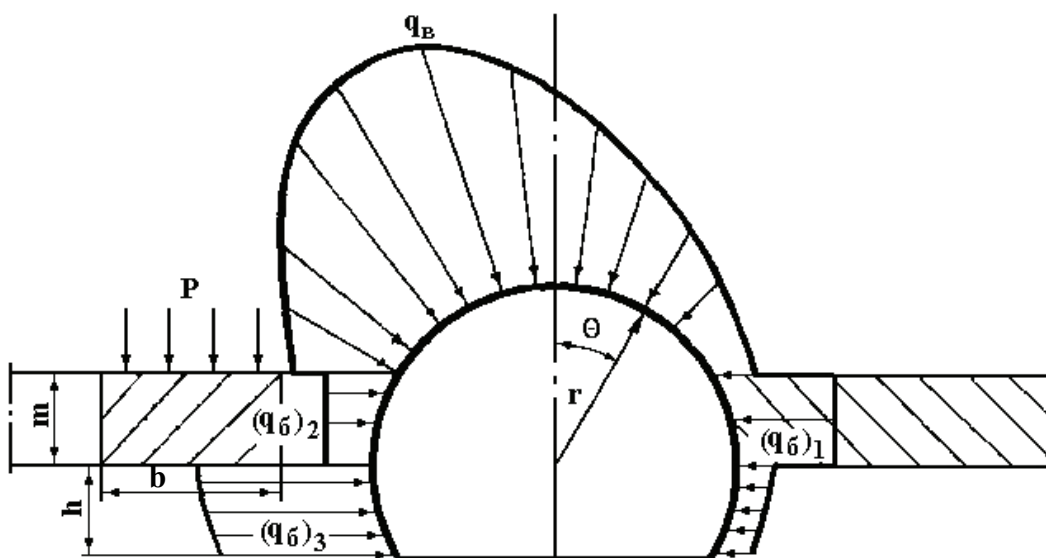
Расчетная схема нагружения крепи выемочной выработки в зоне влияния очистных работ
